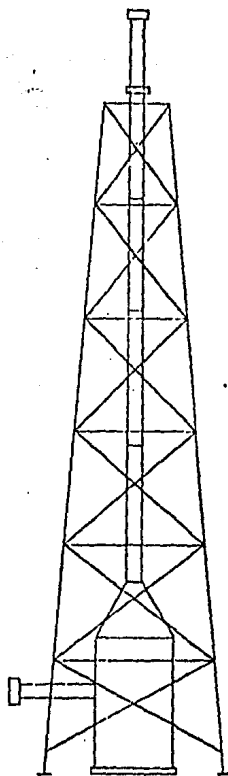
QUEMADOR, ELEVADO TIPO TORRE
